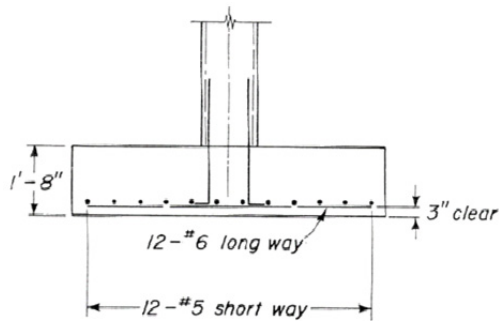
Patrón de armado zapatas aisladas. Teng [10].
